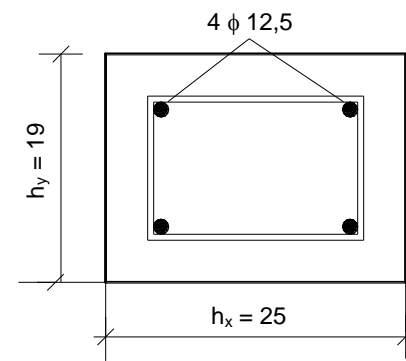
Detalhamento da armadura na seção transversal do pilar P1.
